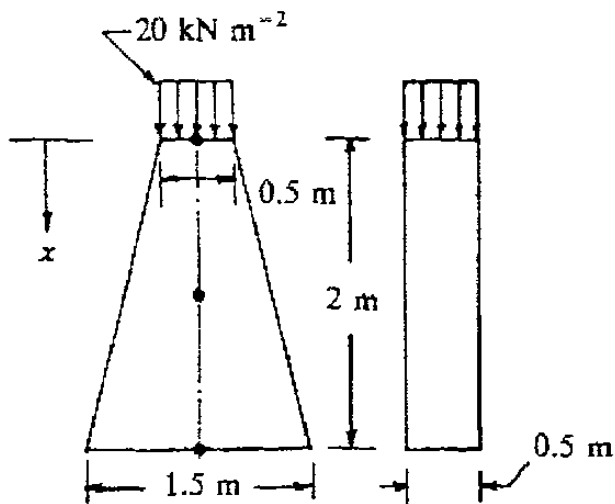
Geometría y carga en el pilar de concreto del problema 3.
